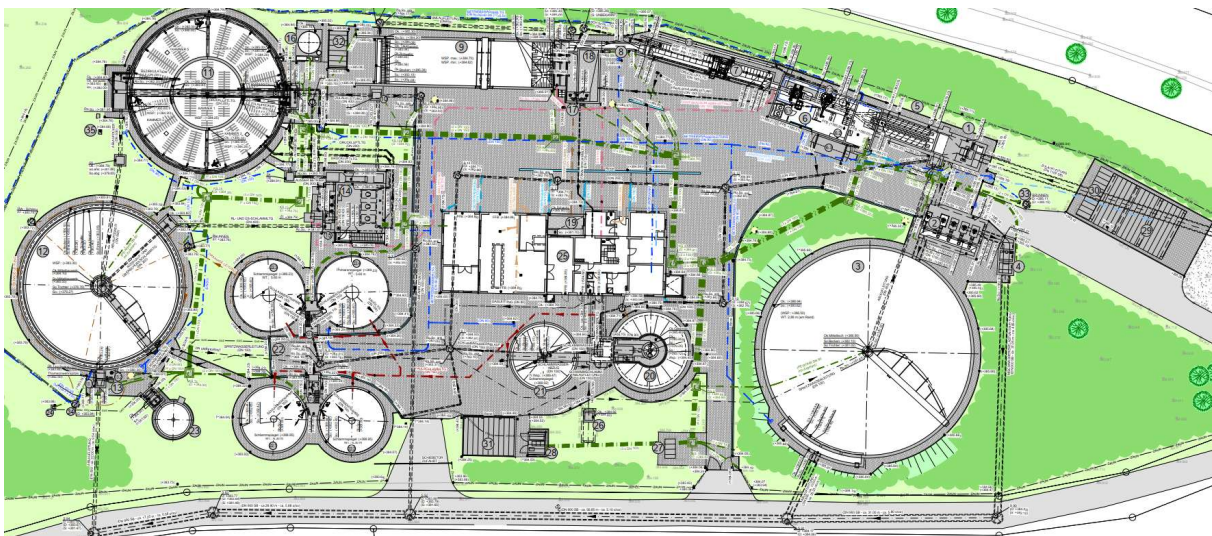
Bestandslageplan Kläranlage Oberes Prümthal (vgl. auch Planunterlagen)
